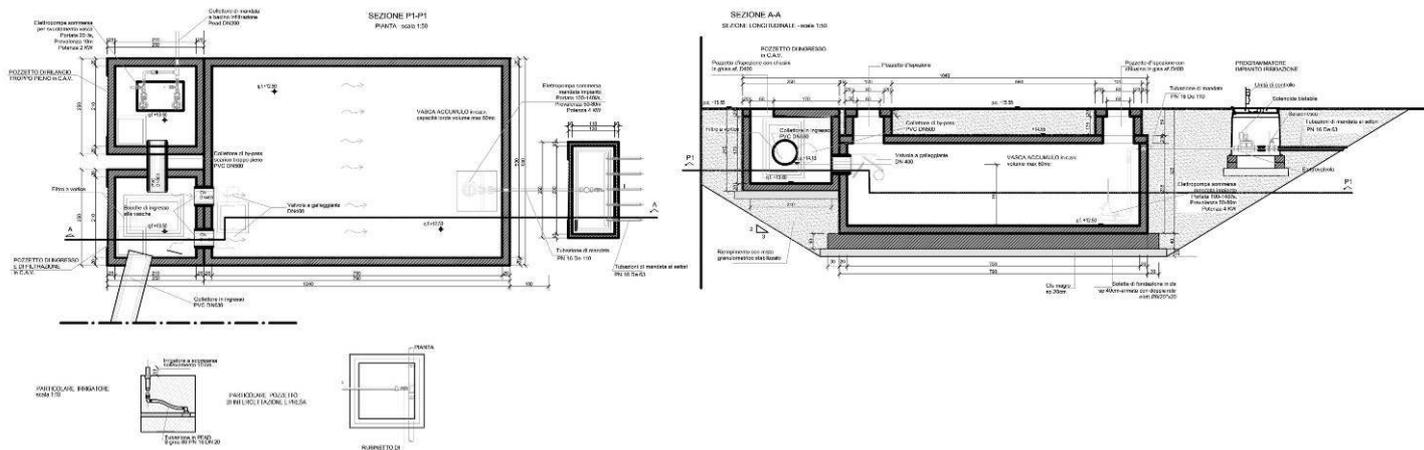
FV010: Pianta e sezione della vasca di accumulo e riutilizzo ai fini irrigui
